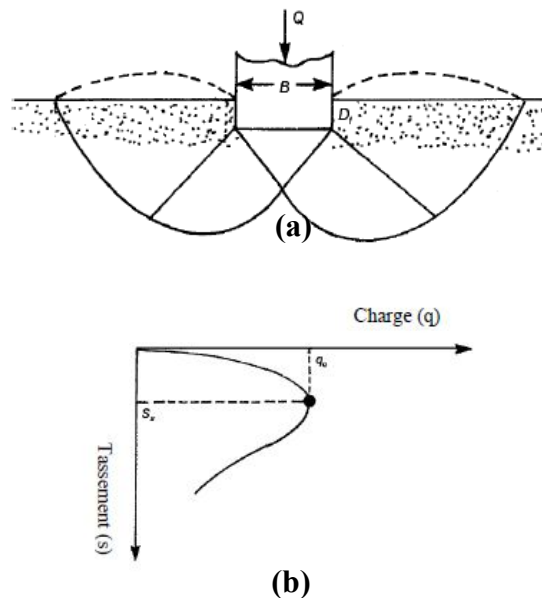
mécanisme de rupture par cisaillement générale dans une fondation.
